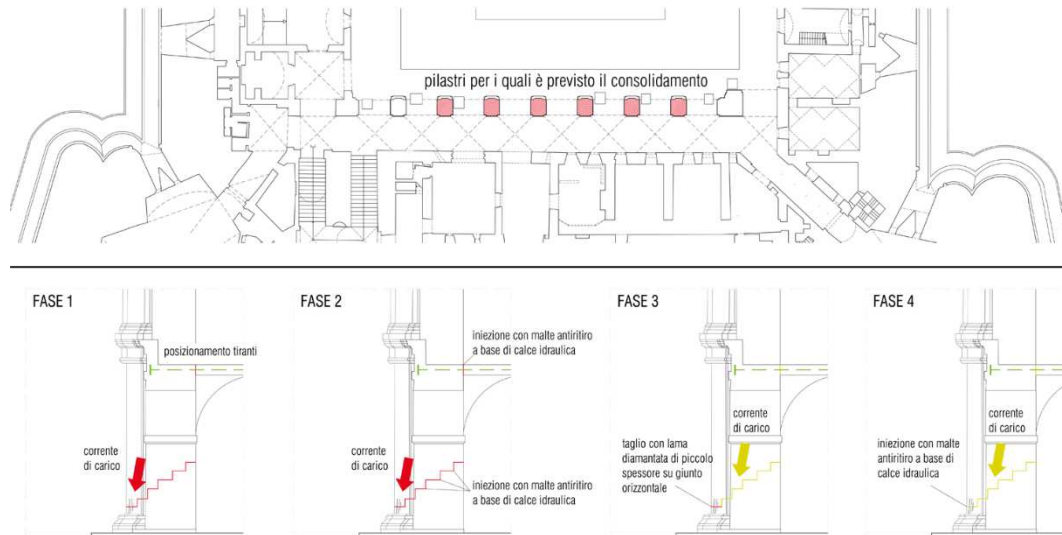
Interventi di consolidamento strutturale dei pilastri del cortile interno
